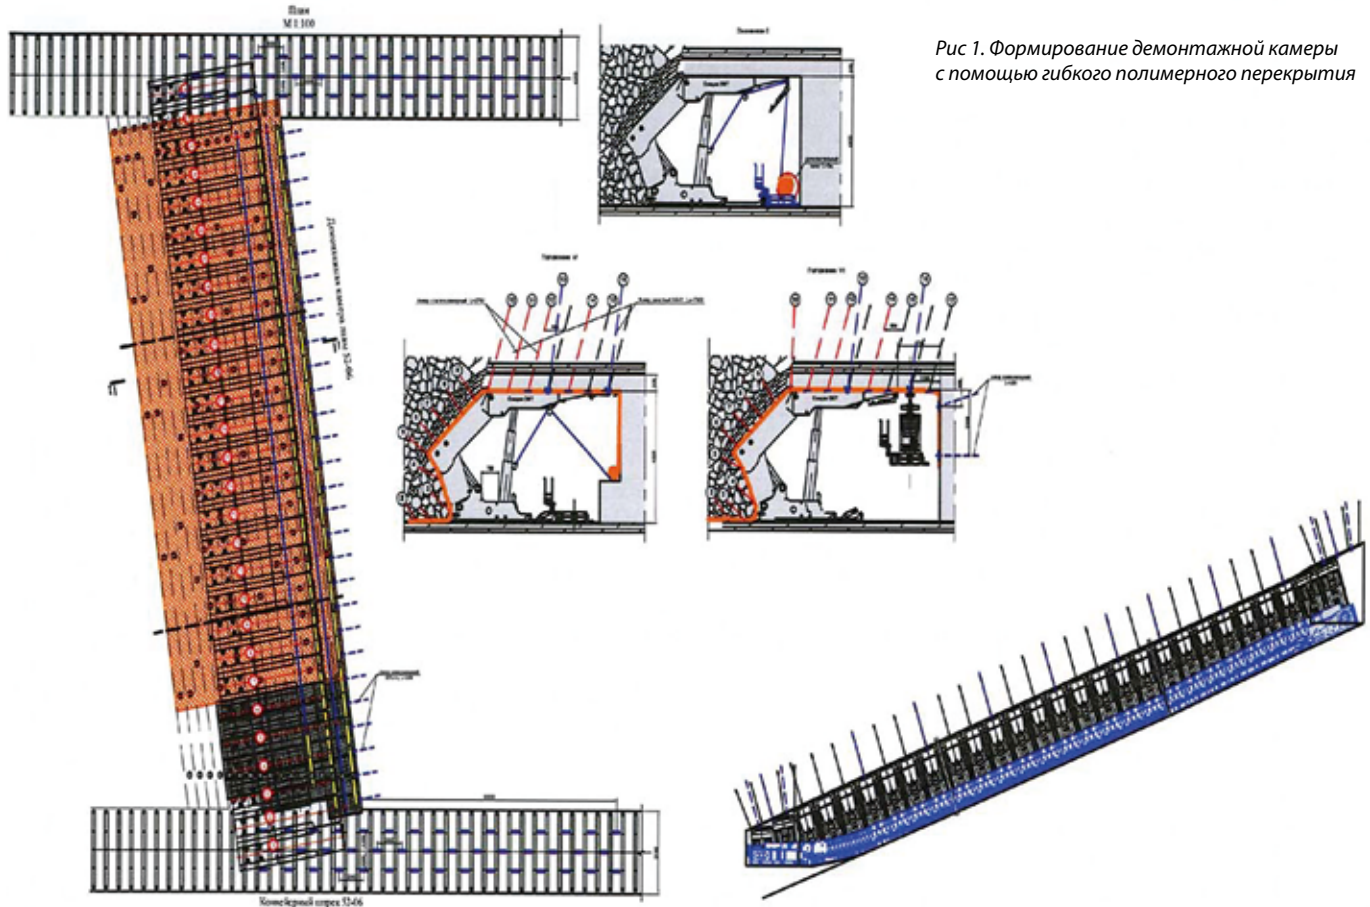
Формирование демонтажной камеры с помощью гибкого полимерного перекрытия
